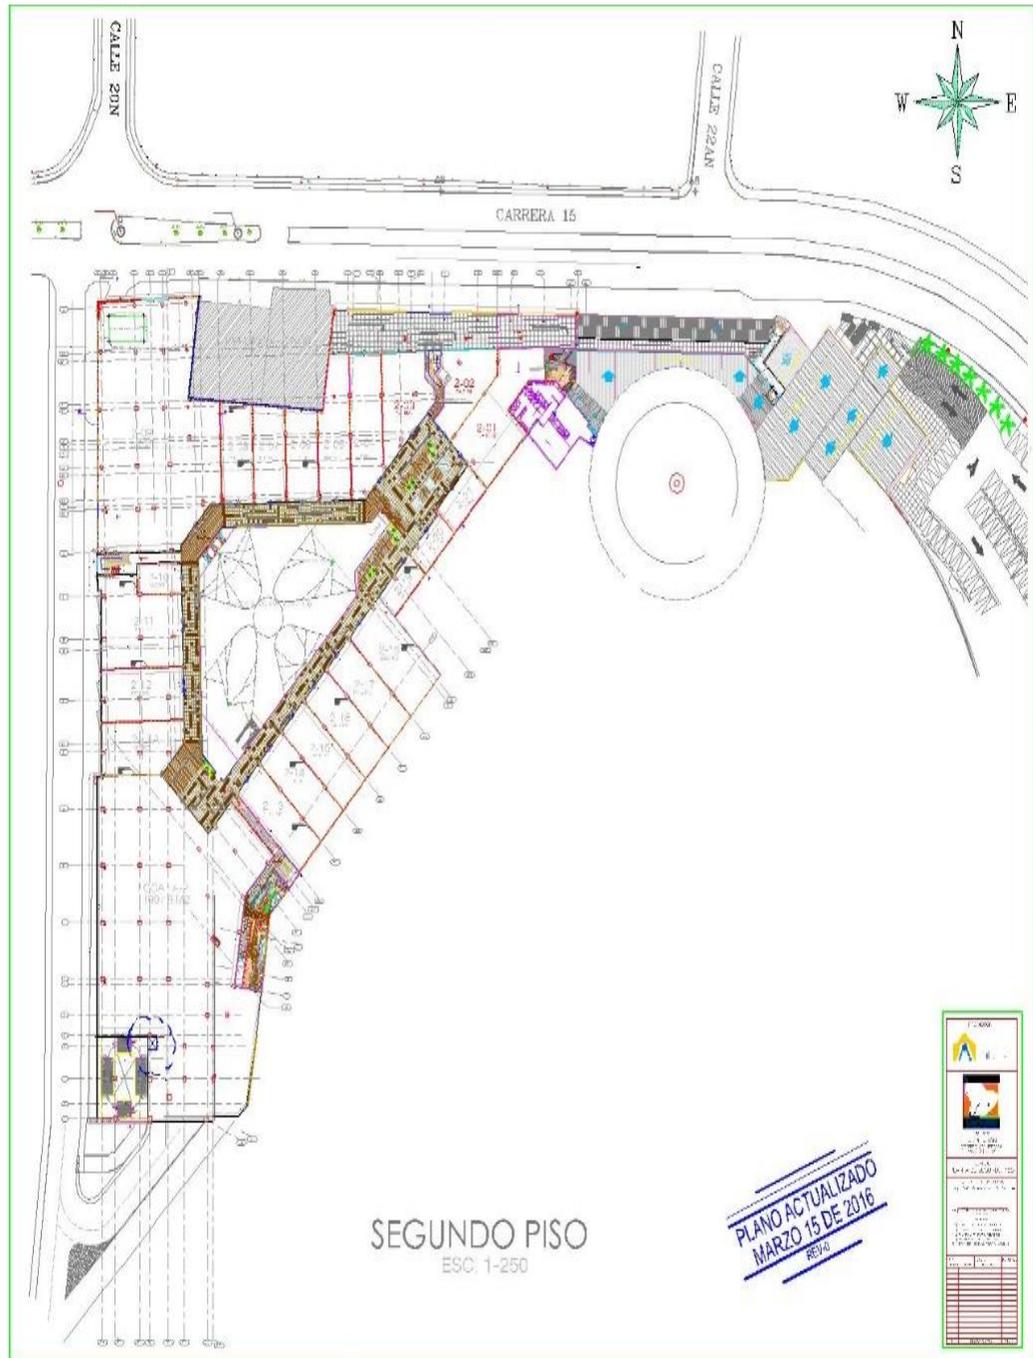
Planta Arquitectónica segundo piso. (Fuente: Diseños Arquitectónicos ARINSA)
